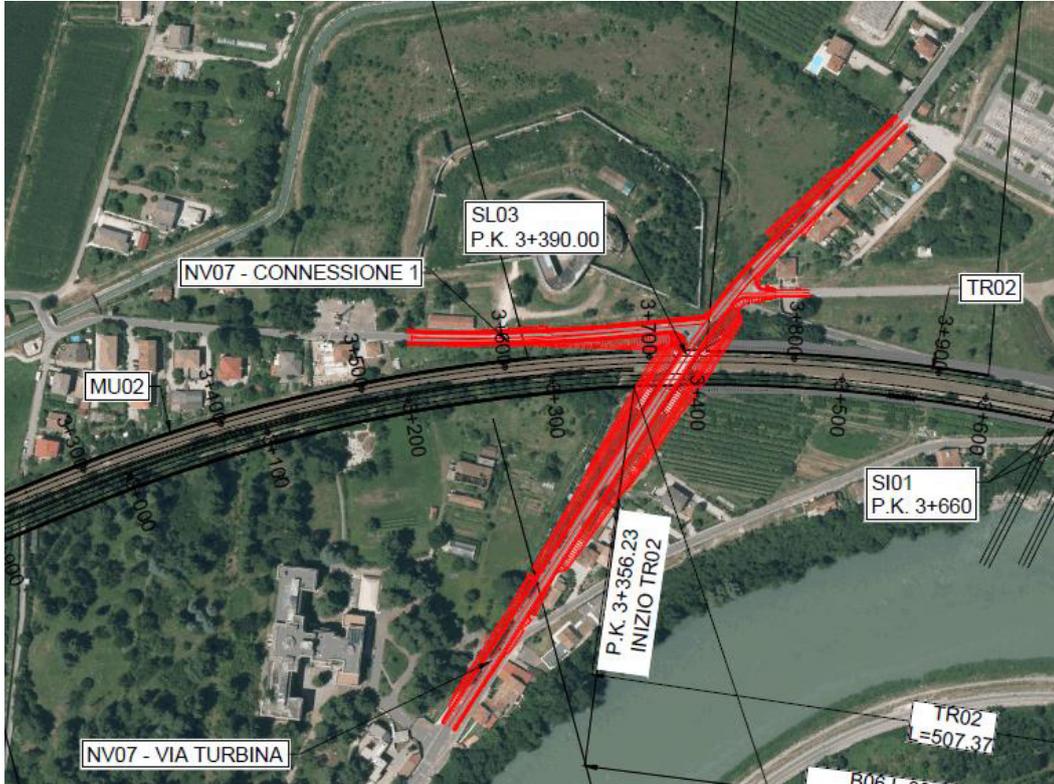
NV07 – Stralcio planimetrico su ortofoto di via Turbina e via Bionde
